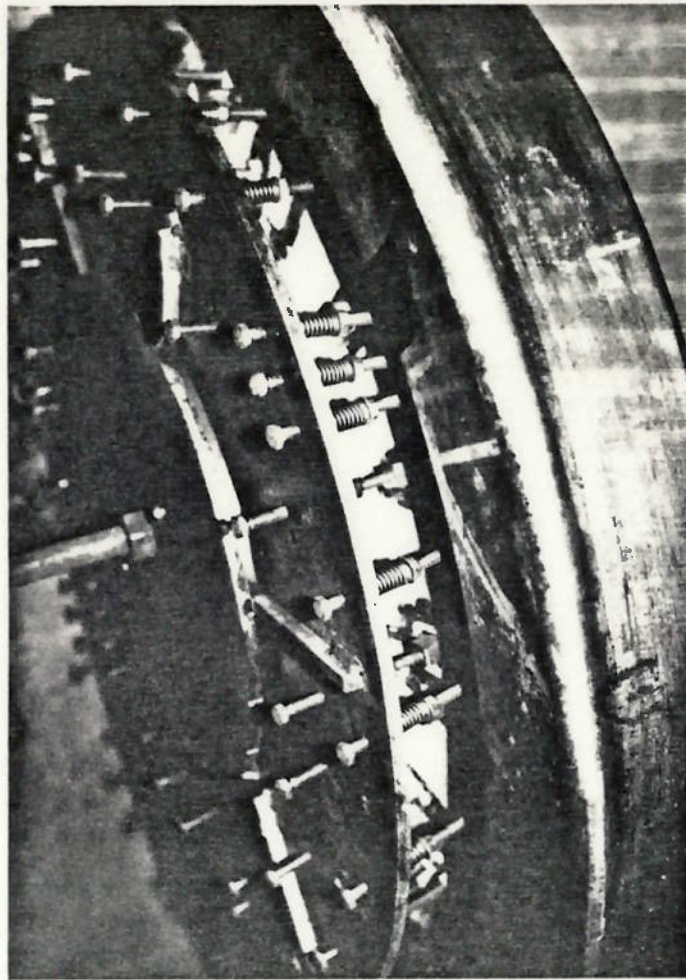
Detalhe do Dispositivo de Fixação dos Extensômetro
